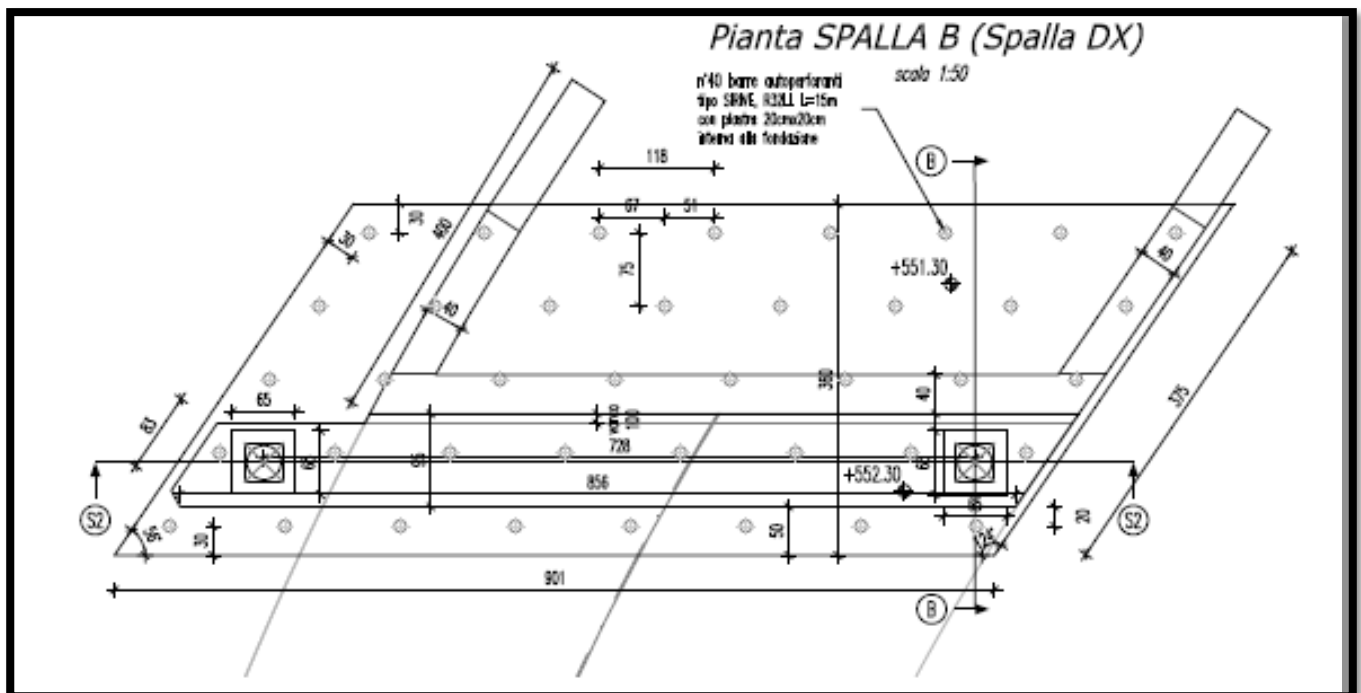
pianta della spalla B (spalla dx)
